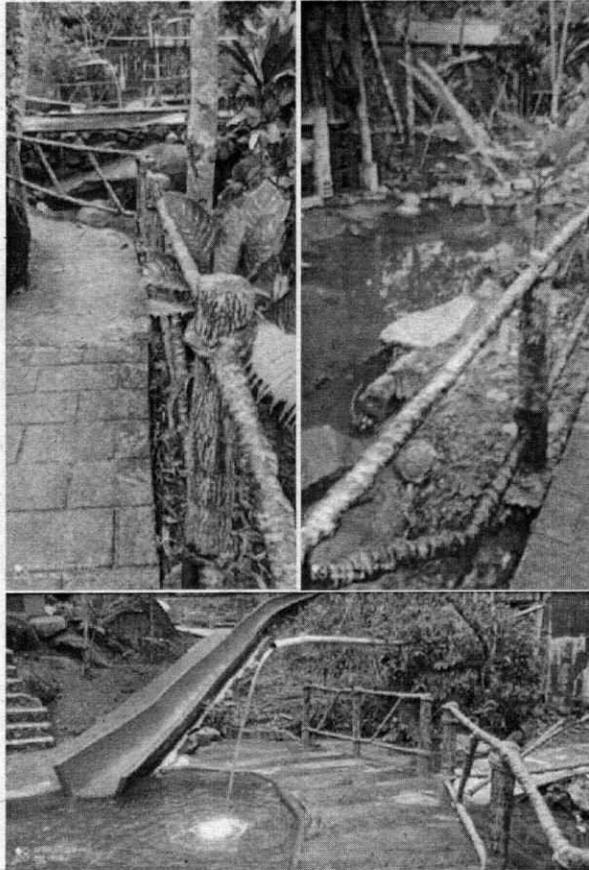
Estado de la placa en concreto reforzado el día 12 de enero del 2021.
